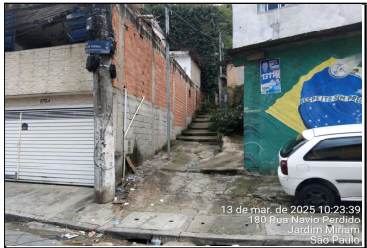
TRAVESSA SÃO JOAQUIM
